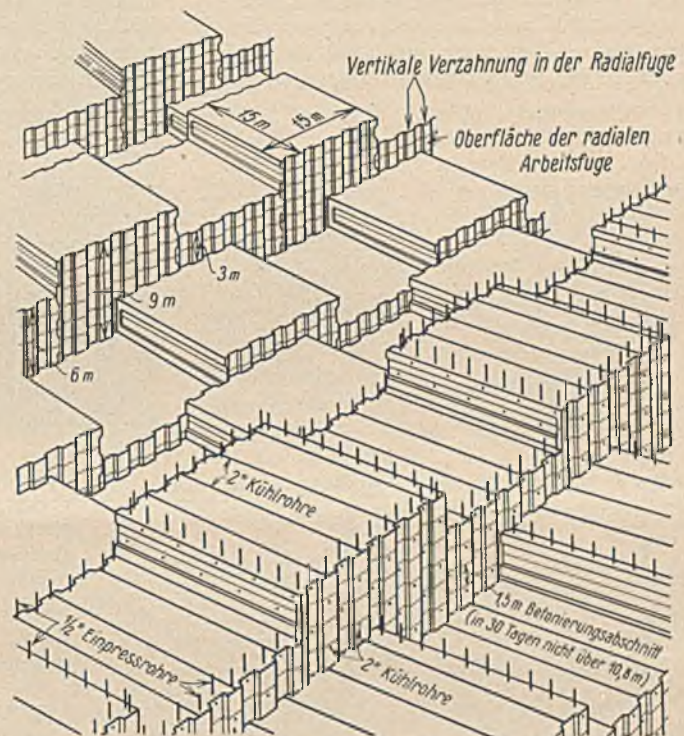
Betonierungsabschnitte bei der Hoover-Staumauer.
